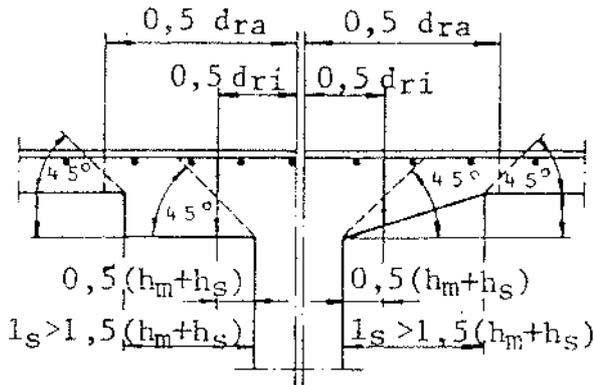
Losa apoyada sobre columnas con refuerzo, según párrafo c), con $l_s > 1,5(h_m + h_s)$.
